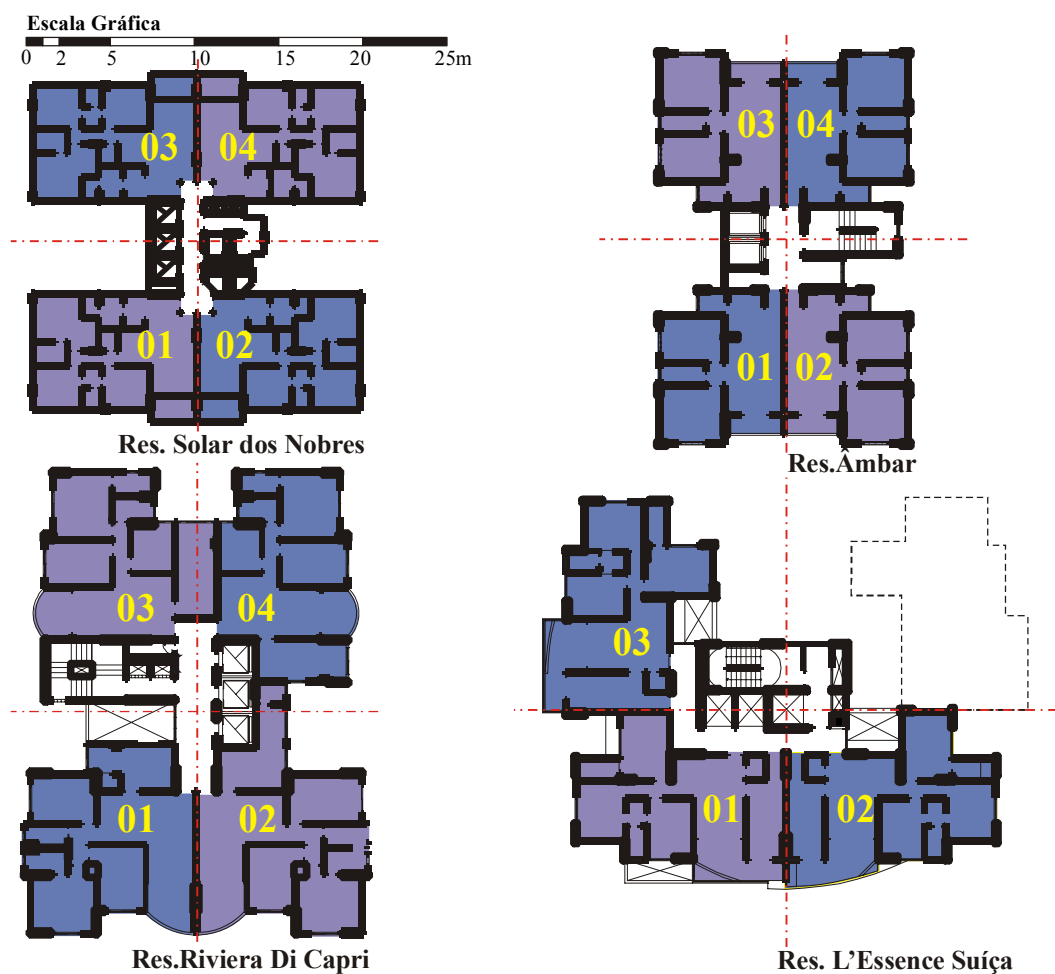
Plantas dos pavimentos tipo – Distribuição das unidades no pavimento
